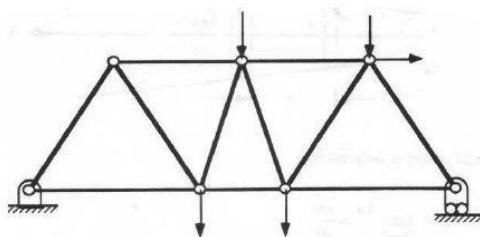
Exemplo de Estrutura Treliçada [49]
